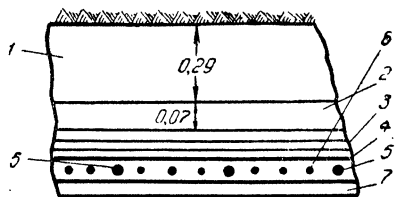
Схема гидроизоляции напорного тоннеля гидроэлектростанции: 1 — бетонная обделка; 2 — железоторкретный слой; 3 — гибкая мембрана; 4 — покровный слой; 5 — монтажные кольца из арматуры $d=16$ мм, устанавливаемые через 35 см; 6 — металлическая сетка из катанки $d=6$ мм; 7 — защитный торкретный слой толщиной 4 см по металлической сетке
